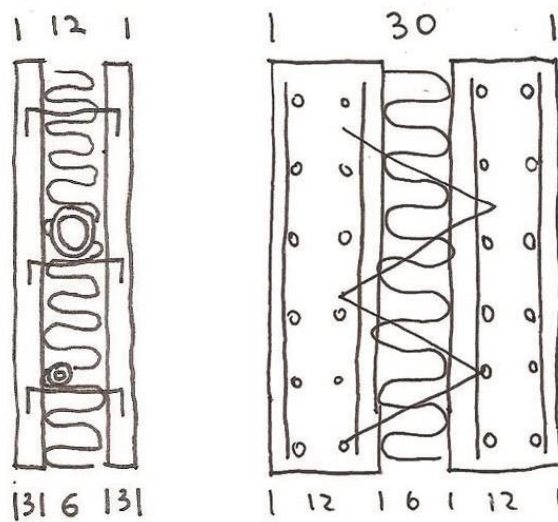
A la izquierda nuevo prototipo de muro estructural prefabricado con HUAC con aislamiento e instalaciones en su interior. A la derecha mismo muro estructural prefabricado realizado en hormigón tradicional.
